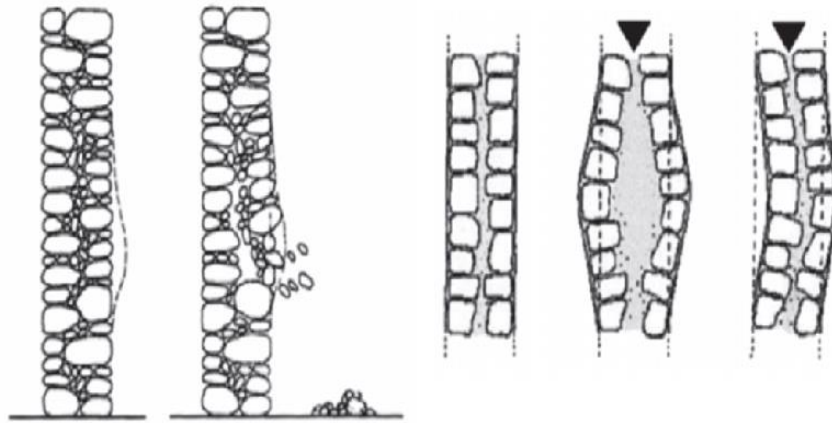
Desagregação e falha de alvenaria (Retirado de *Fracture and failure of natural building stones*, 2006)
